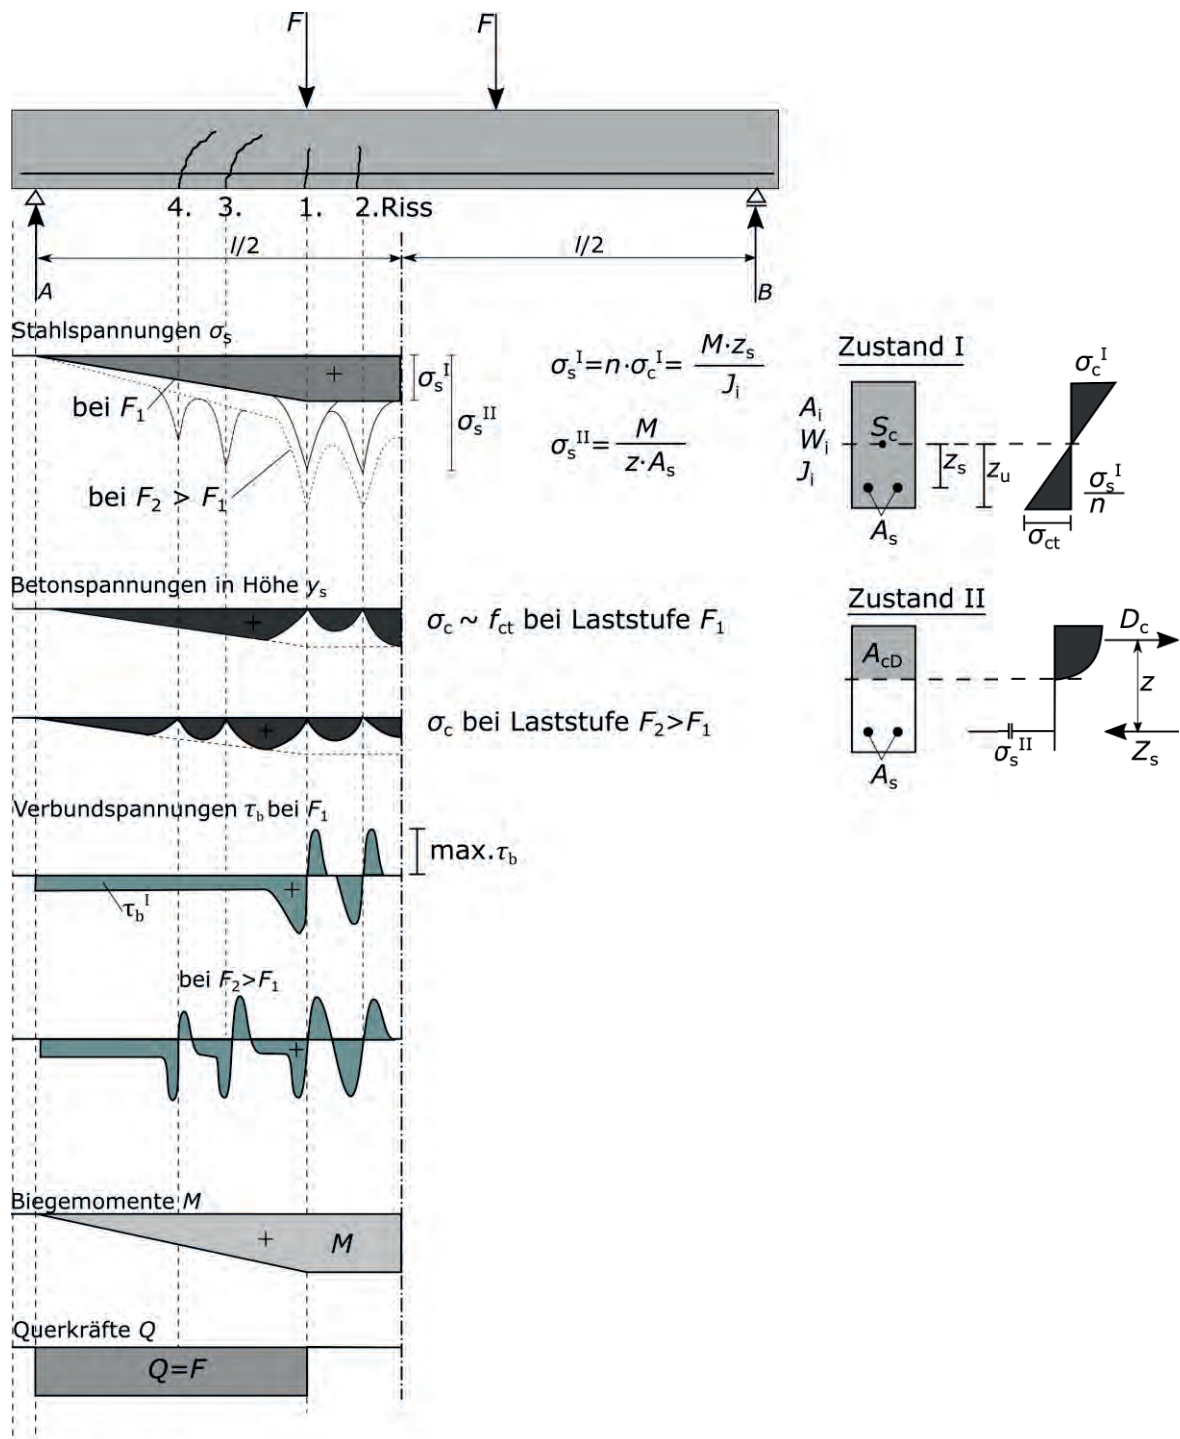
Stahlbetonbiegebalken im gerissenen und ungerissenen Zustand nach Leonhardt 1984
